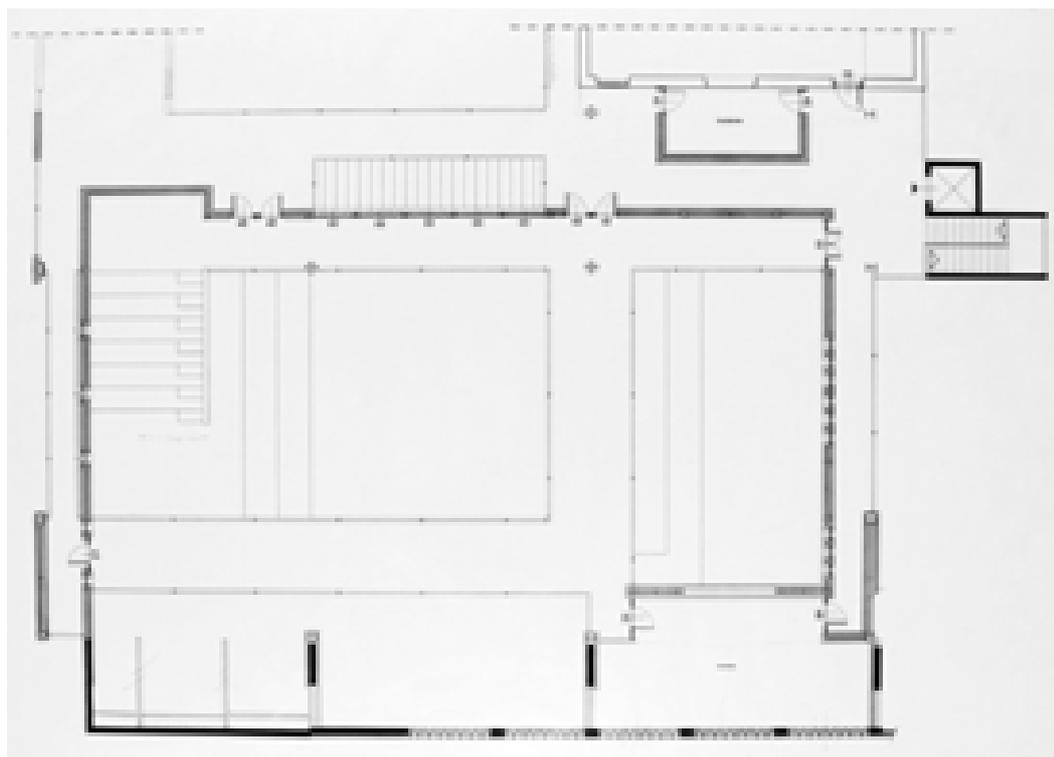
Pianta esecutivo piano secondo –01/07/1996 (AABS-1996.944)
